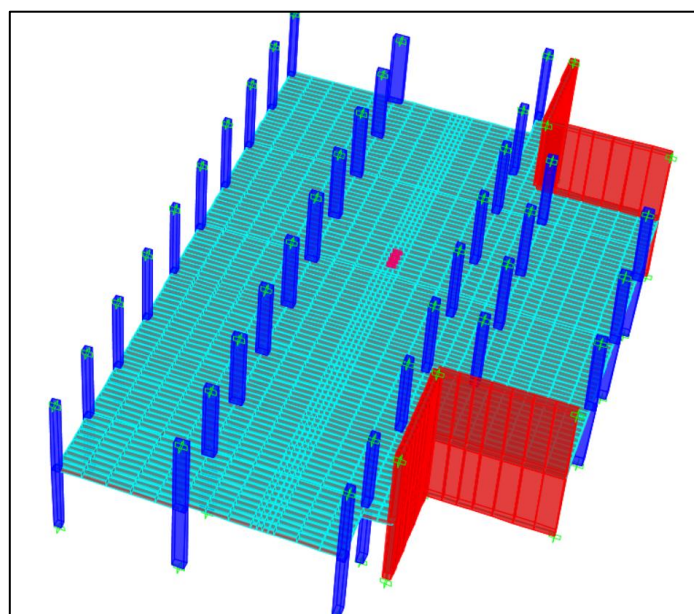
Modellazione soletta piena in calcestruzzo armato del 1° piano interrato; in rosa è evidenziata la posizione del carico
